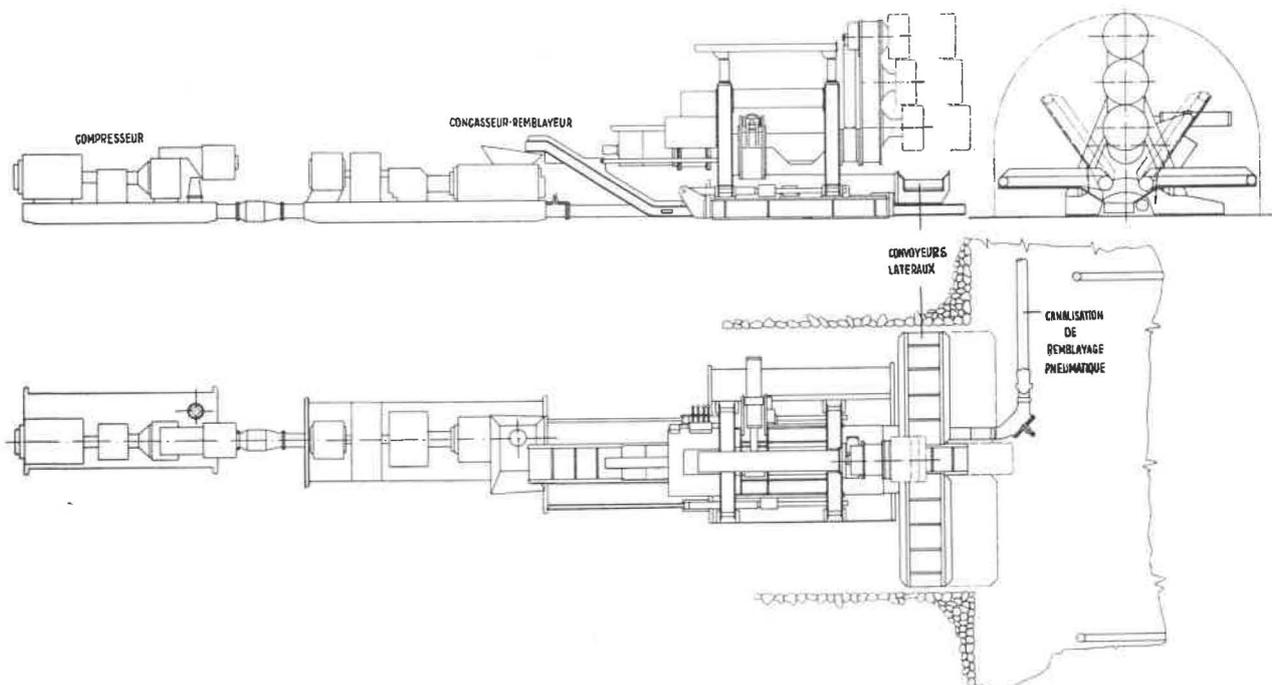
Disposition schématique de la machine à bosseyer, du concasseur remblayeur, des convoyeurs et des tuyauteries de remblayage (Bosseyement voie de base).
